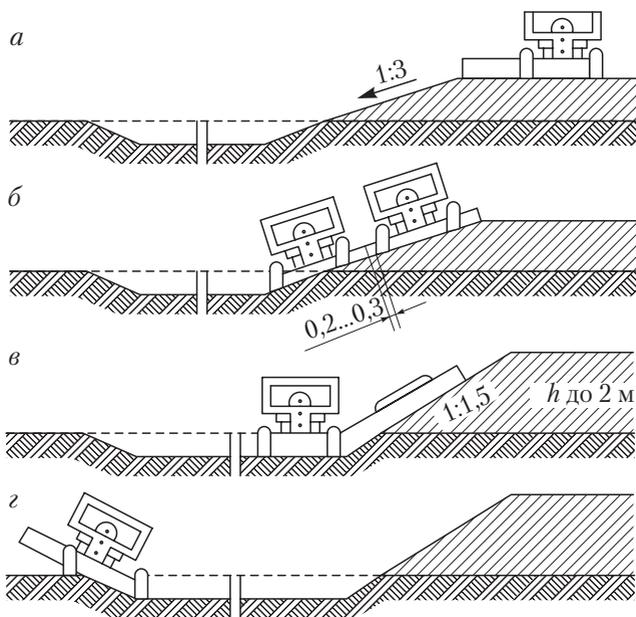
Схема планировки земельного полотна автогрейдером: а – планировка поверхности; б – планировка откосов крутизной 1:3; в – планировка откосов 1:1,5 и высотой земельного полотна до 2 м; г – планировка внешнего откоса резерва
